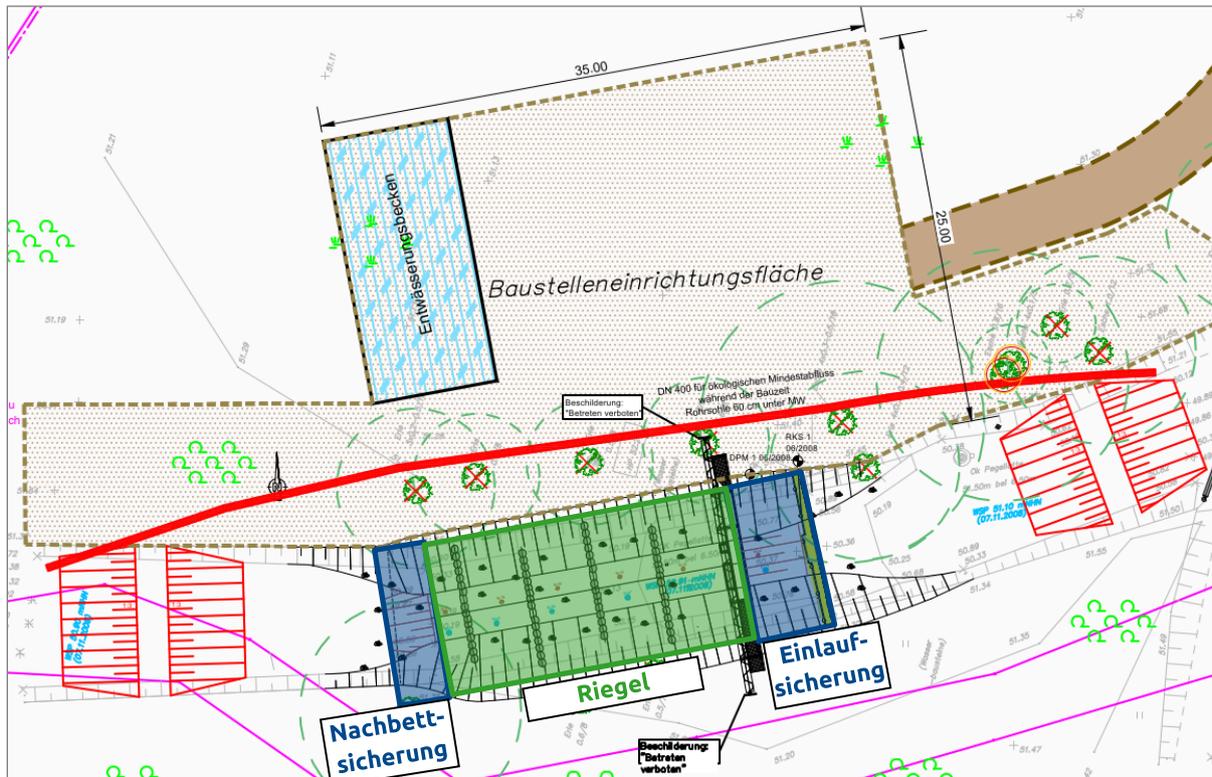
Wehr 45 - Überblick zu benötigten Wasserhaltungen (Lageplan aus /P3/)
